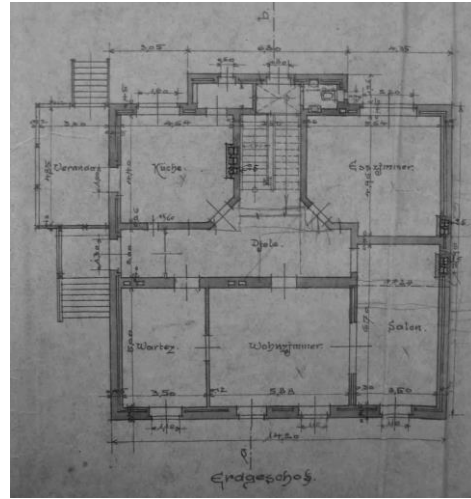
Grundriss Erdgeschoss
